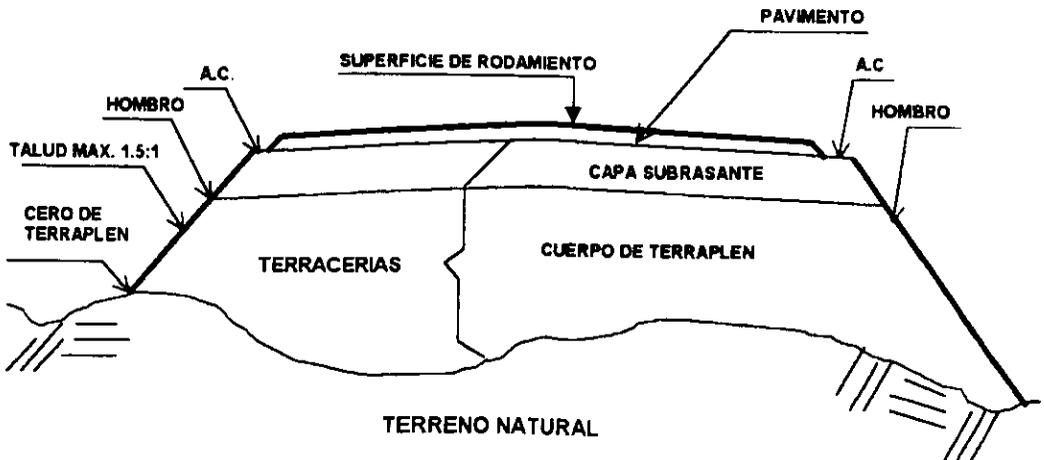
SECCION TRANSVERSAL TÍPICA EN TERRAPLEN DE UN PAVIMENTO
